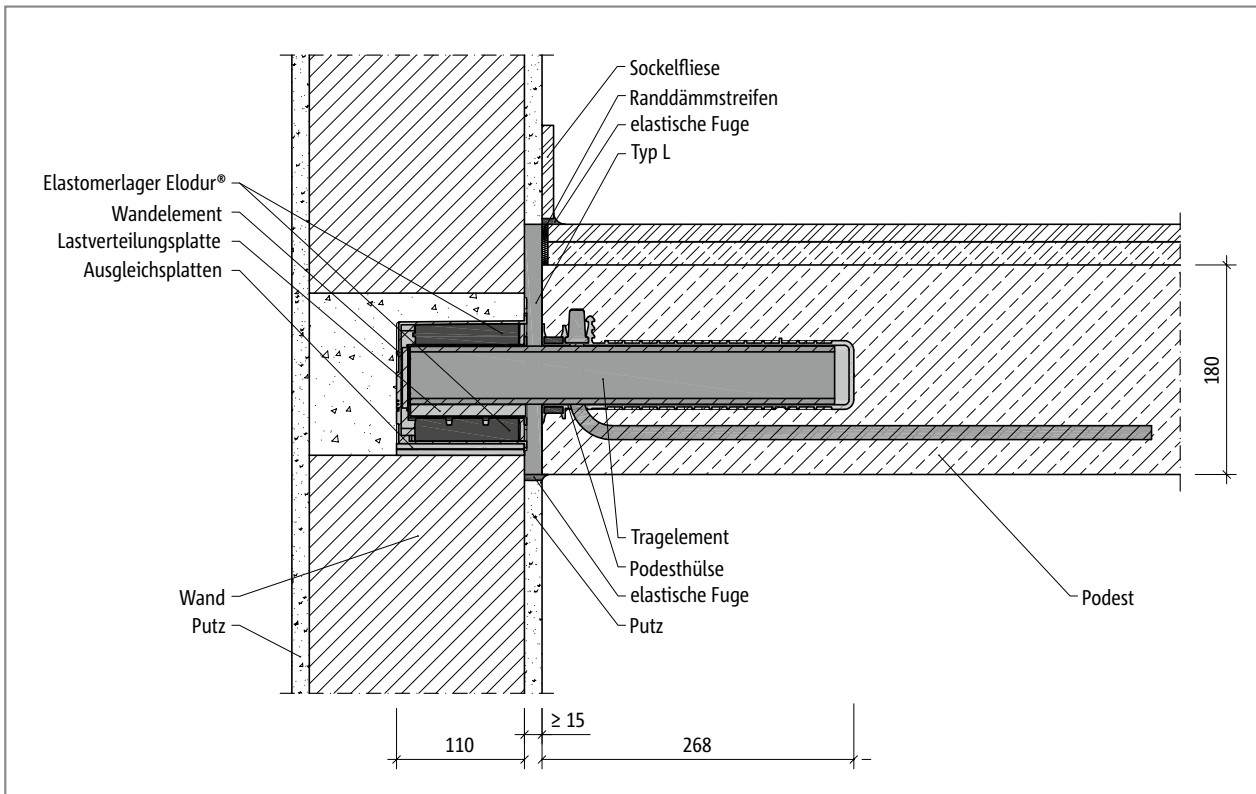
Schöck Tronsole® Typ P: mit Ortbetonpodest und Tronsole® Typ L
